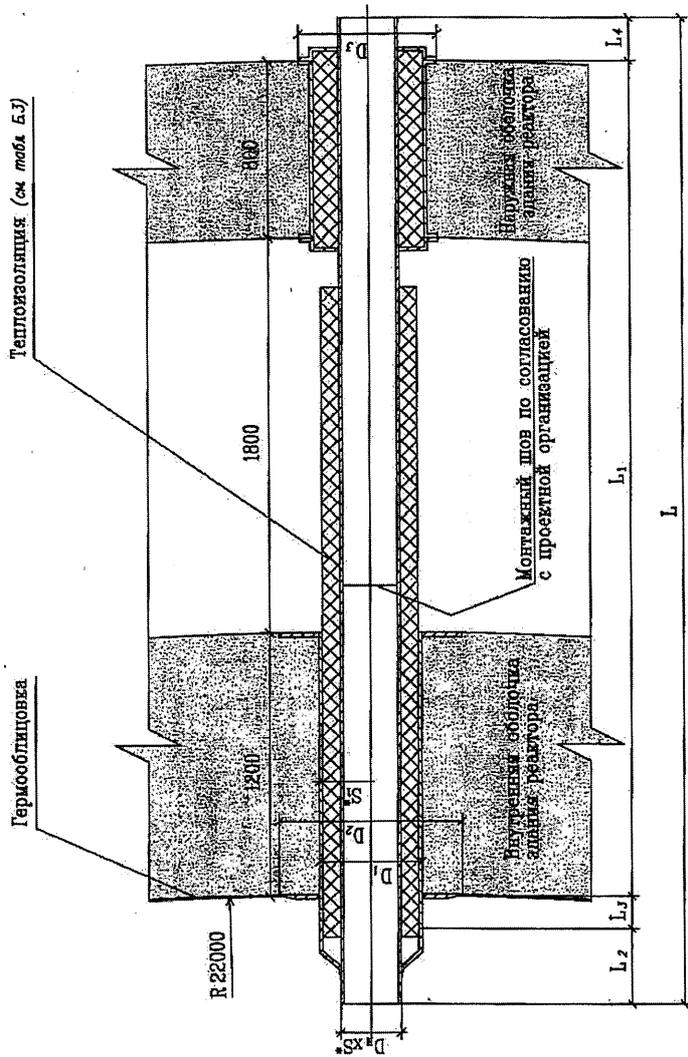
Габаритный чертеж герметичной проходки
